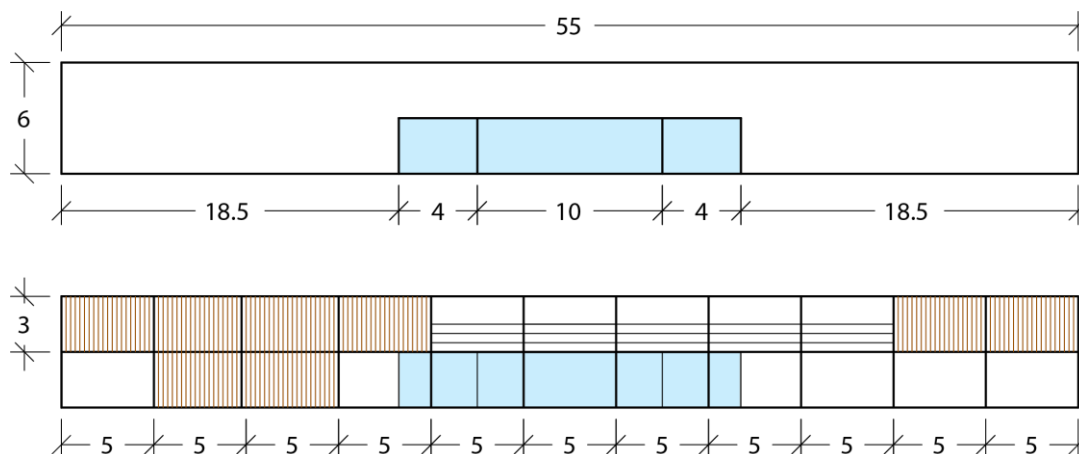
a. Dimensões alçado fachada principal sem elementos de sombreamento; b. Dimensões alçado fachada principal com galeria em pórtico
